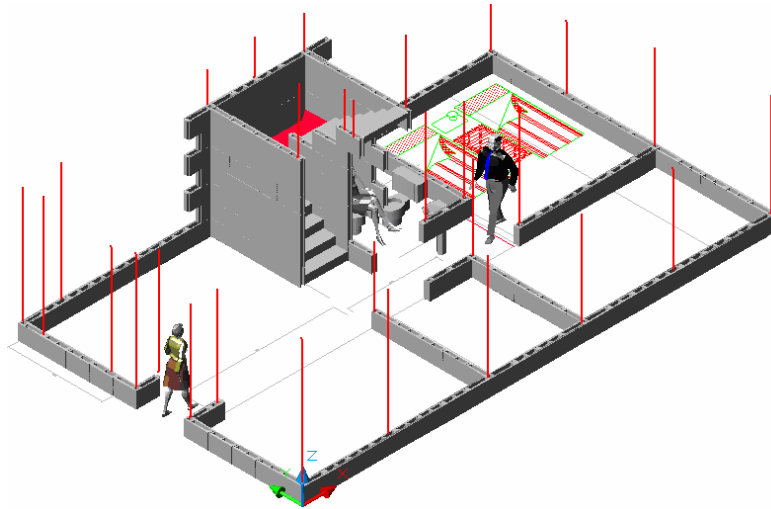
DISTRIBUCIÓN ARQUITECTÓNICA, MARCADA POR PRIMERA HILADA INYECTADA, Y ACEROS DE LOS ELEMENTOS DE CONFINAMIENTO ANGLADOS EN LA CIMENTACIÓN.
